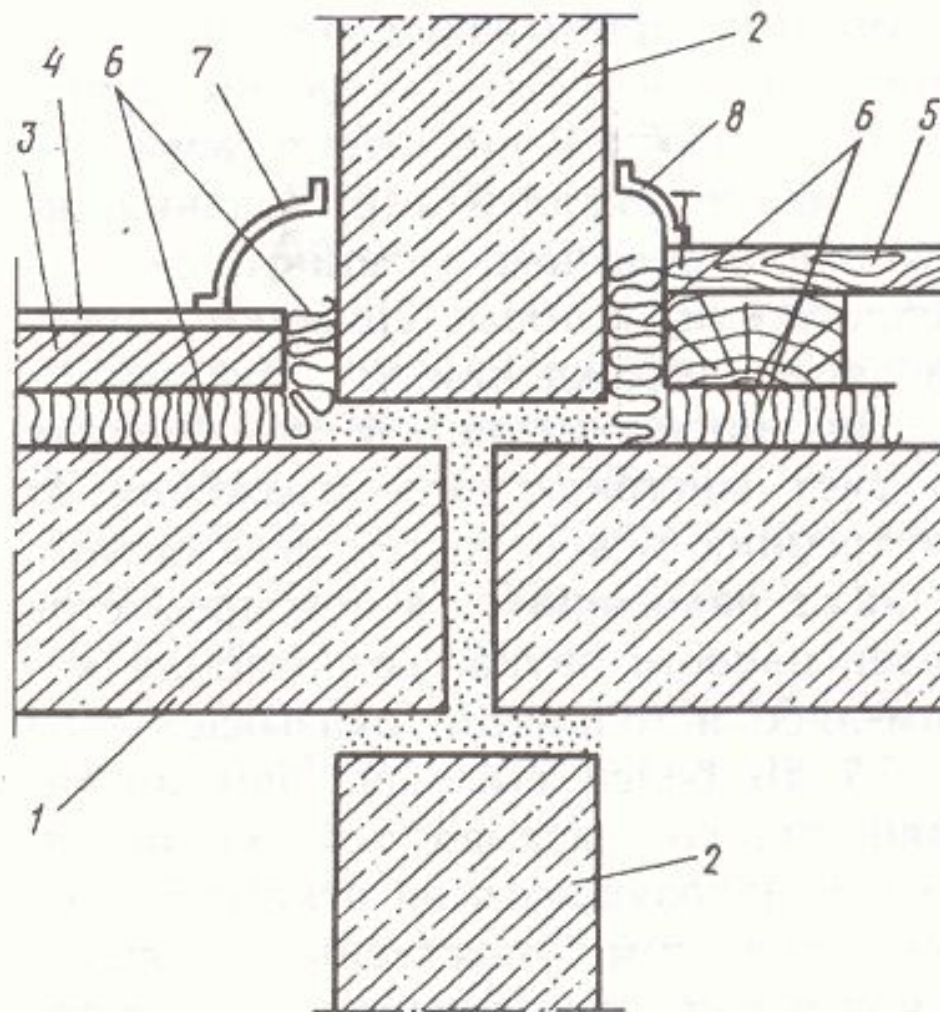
Примыкание пола на звукоизоляционной прослойке к стене
